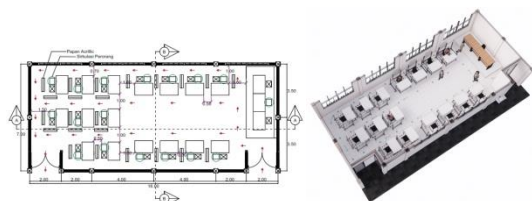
Denah Ruang 4-1 tipe Rectangle
